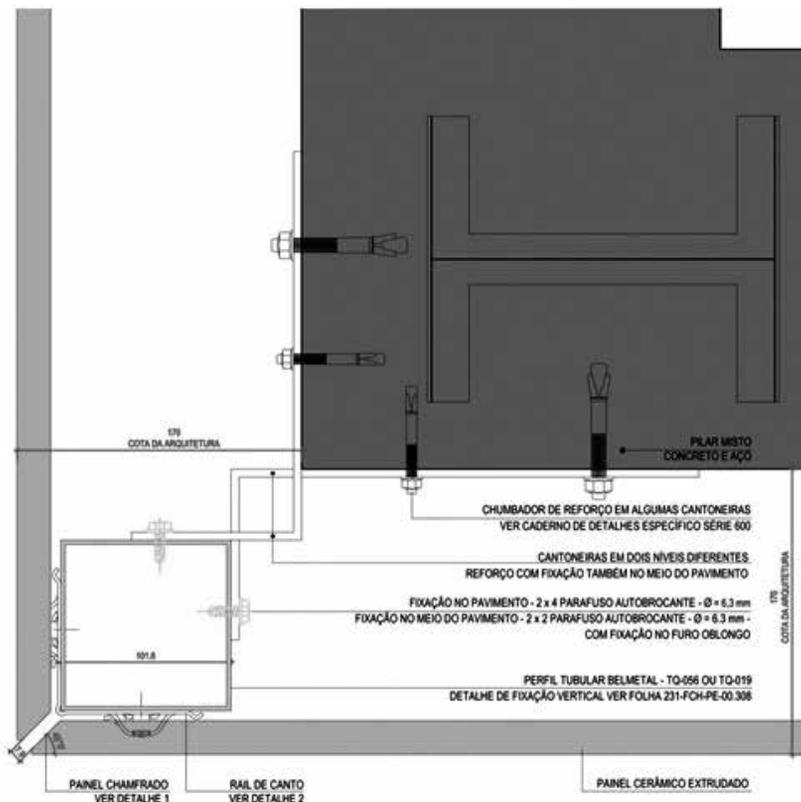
Detalhe em planta do encontro de dois painéis cerâmicos de um revestimento ventilado. (Acervo INOVATEC CONSULTORES)
